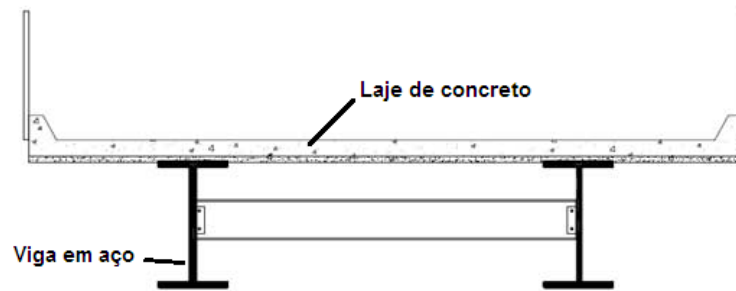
Detalhe da estrutura básica de uma ponte mista em aço e concreto.
